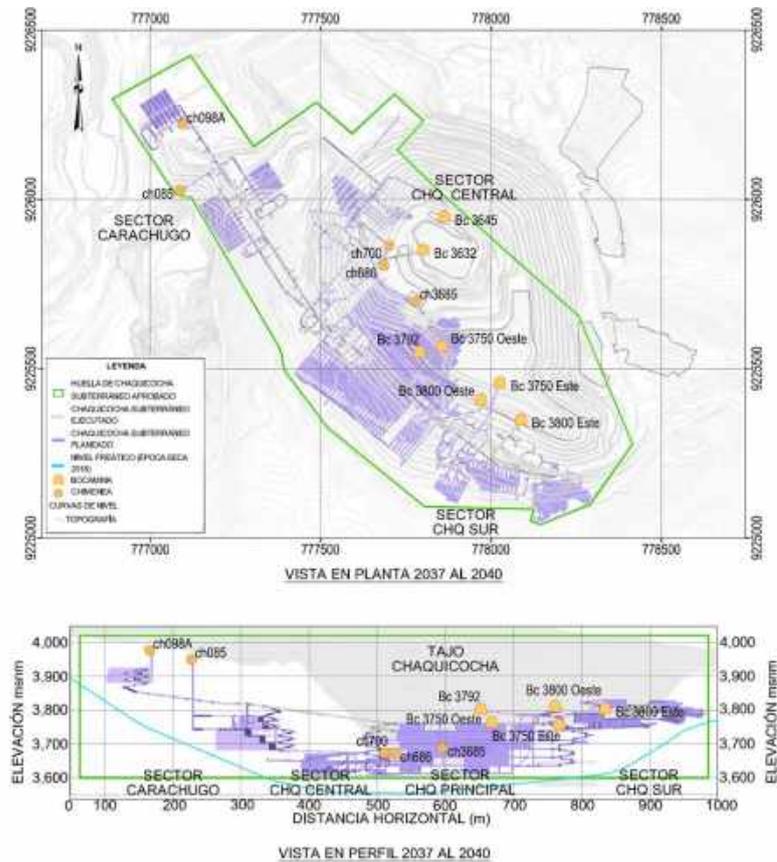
Plan de producción de Chaquicocha Subterráneo – año 2037 - 2040 – Vista en planta y perfil
